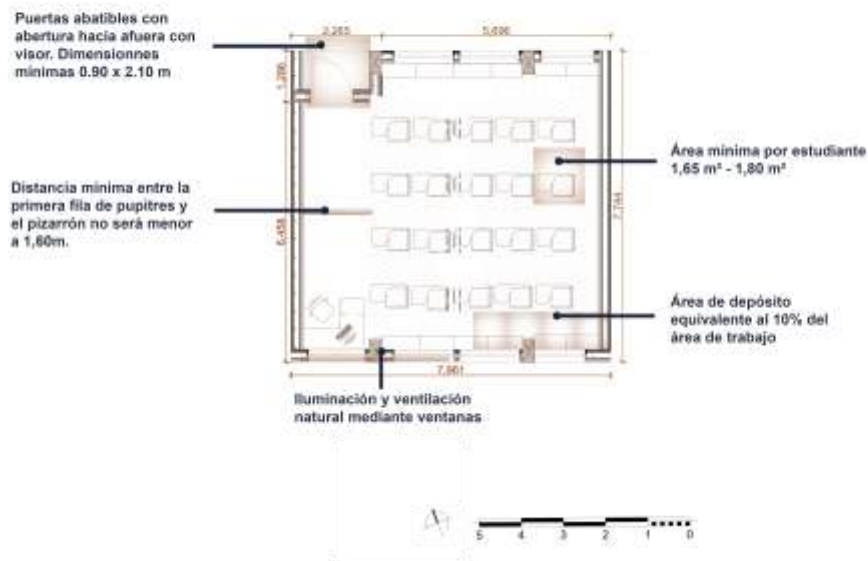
Planta a detalle módulo aulas educación inicial.
